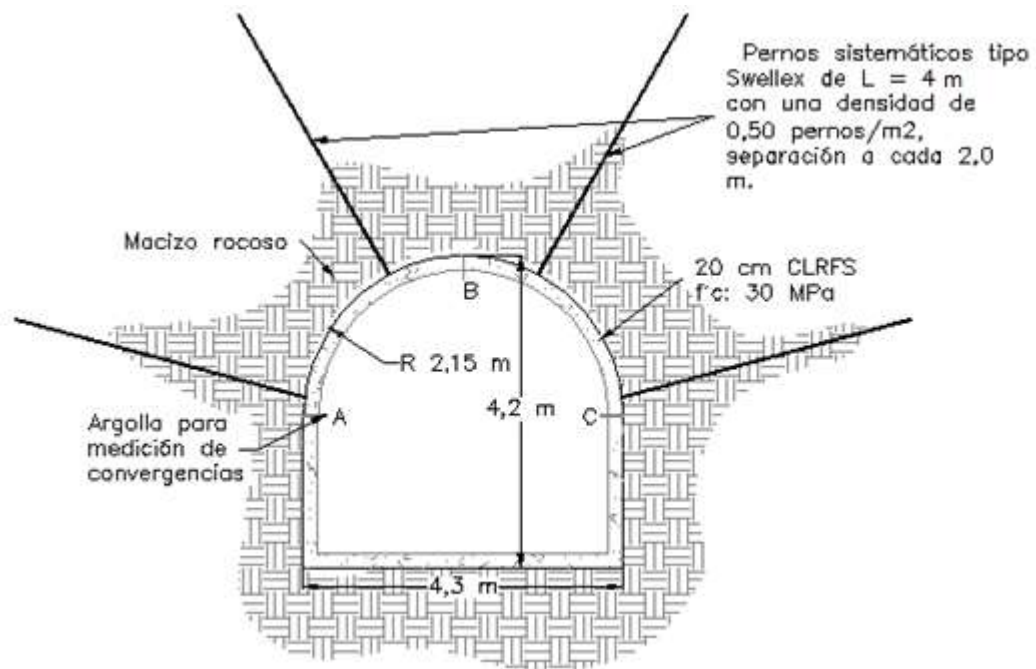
Detalle del tipo de soporte temporal SP-2
